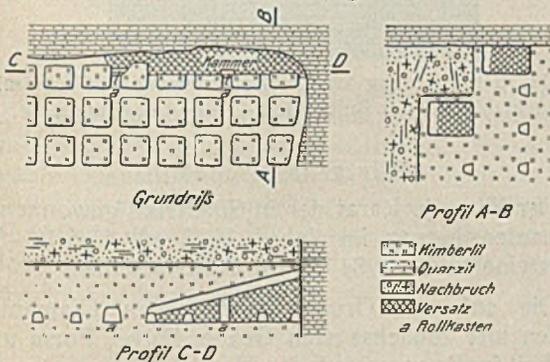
Abbau des Kimberlits im Grundriß und Profil.
